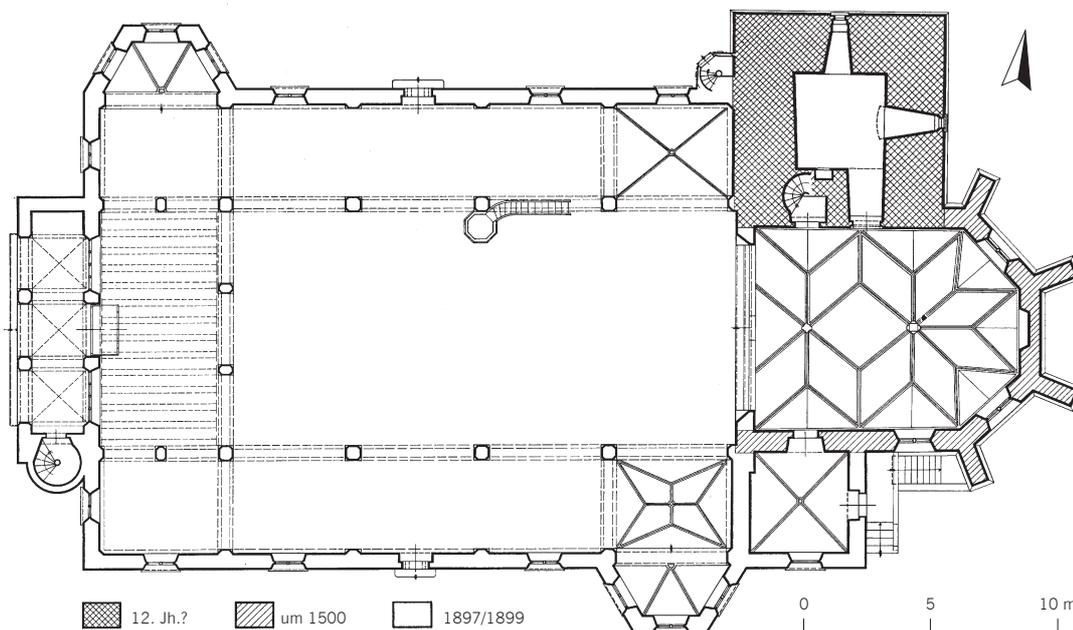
Merenschwand AG Pfarrkirche St. Vitus, Grundriss 1:300.
